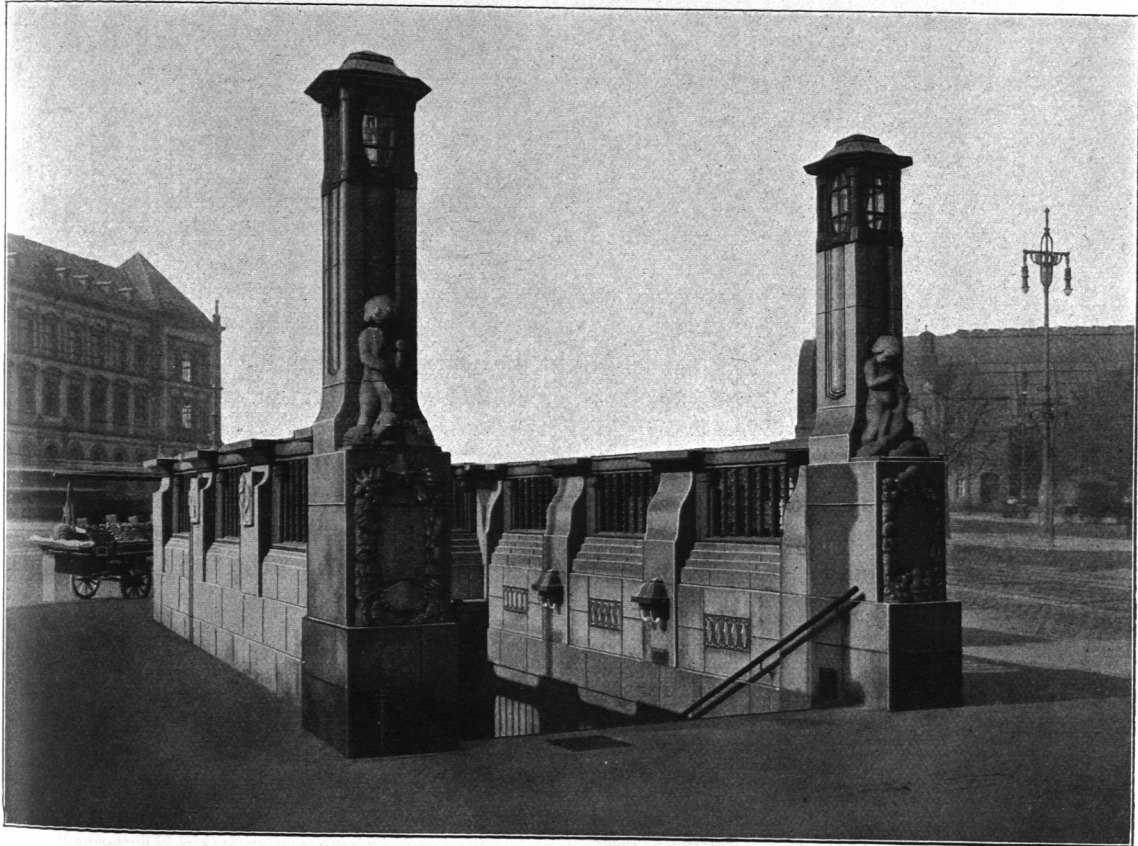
Haltestelle Hauptbahnhof, Straßeneingang.
